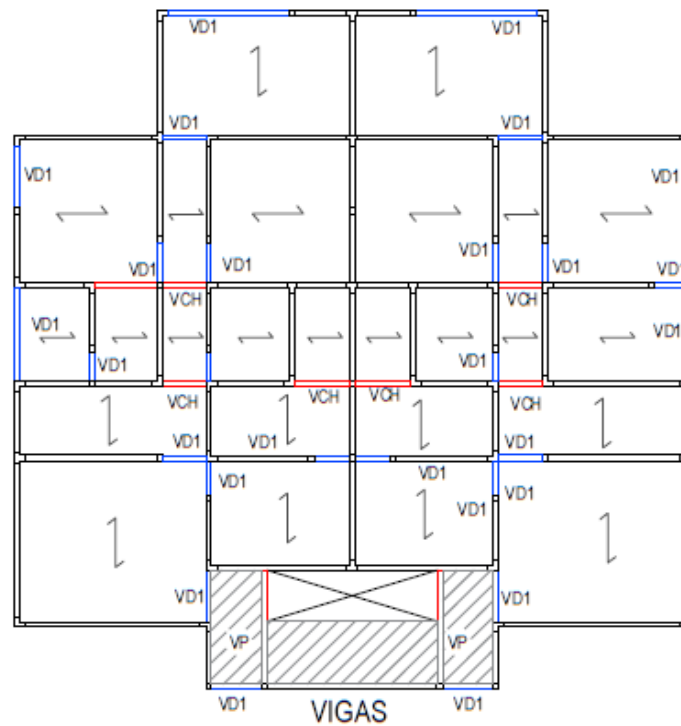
Vigas, Losa Aligerada y Losa Maciza
